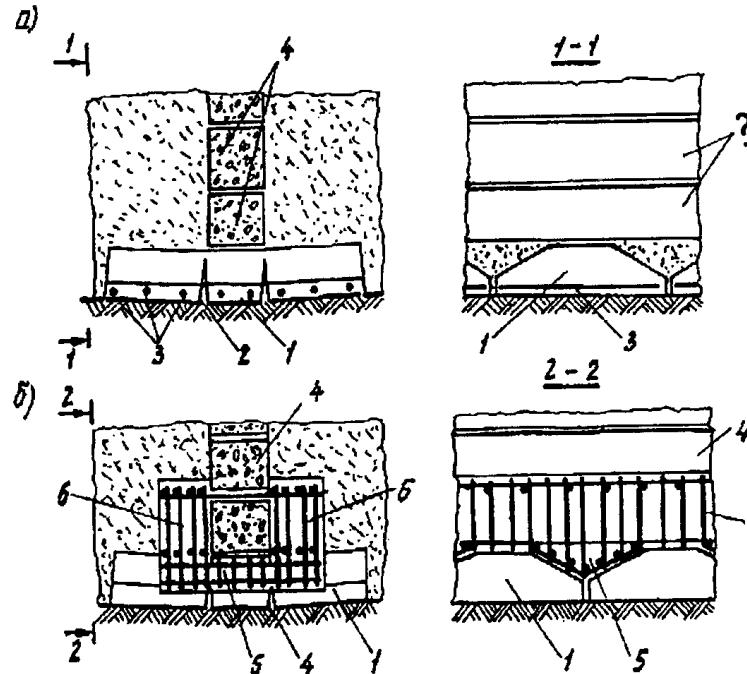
Схема разрушения фундамента из-за неправильной укладки железобетонных подушек и конструкции усиления (а — фрагмент фундамента; б — деталь усиления фундамента):
